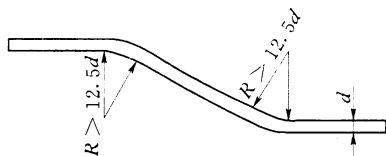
弯起钢筋弯折处圆弧内半径示意图
